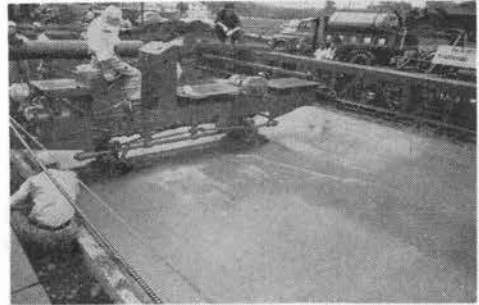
コンクリートレベリングフィニッシャ丸善舗道
